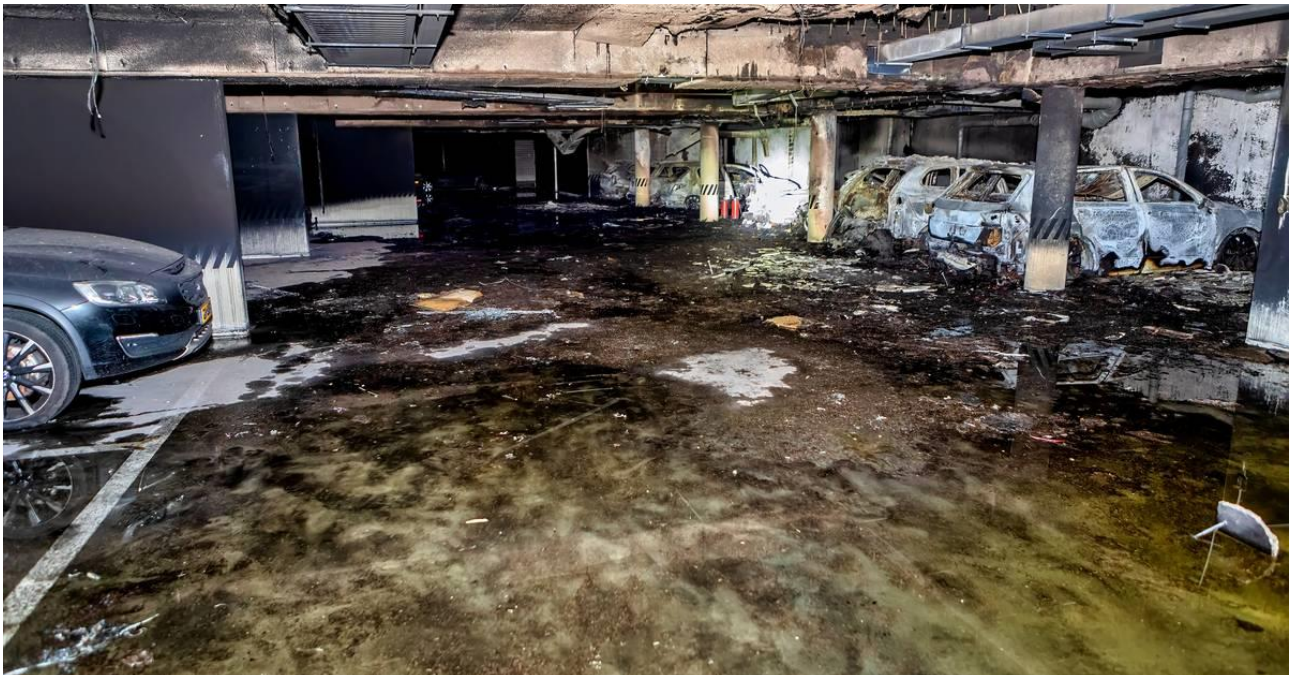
Brand in parkeergarages leidt vaak tot schade aan de constructie, vloeren en aanwezige installatietechniek waardoor de bewoonbaarheid na brand ernstig in gevaar komt.
